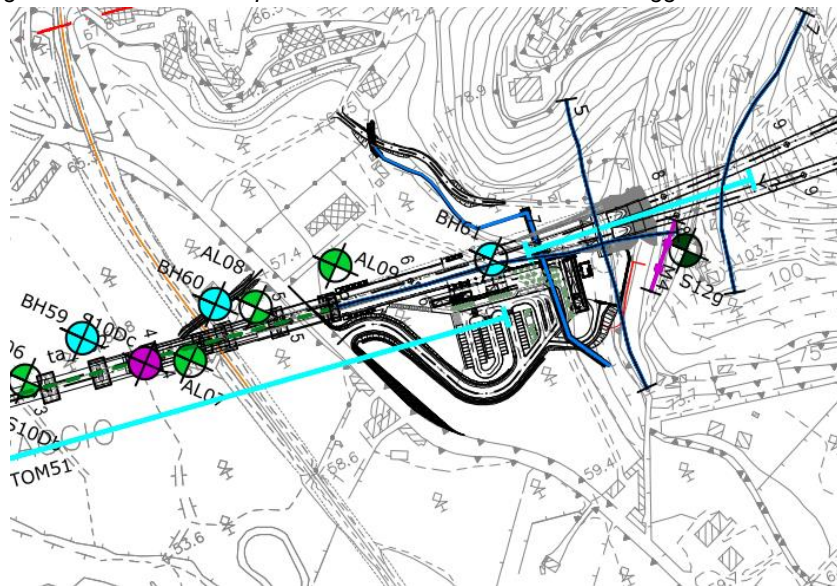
Stralcio della planimetria con ubicazione dei sondaggi da BH59 a BH61
